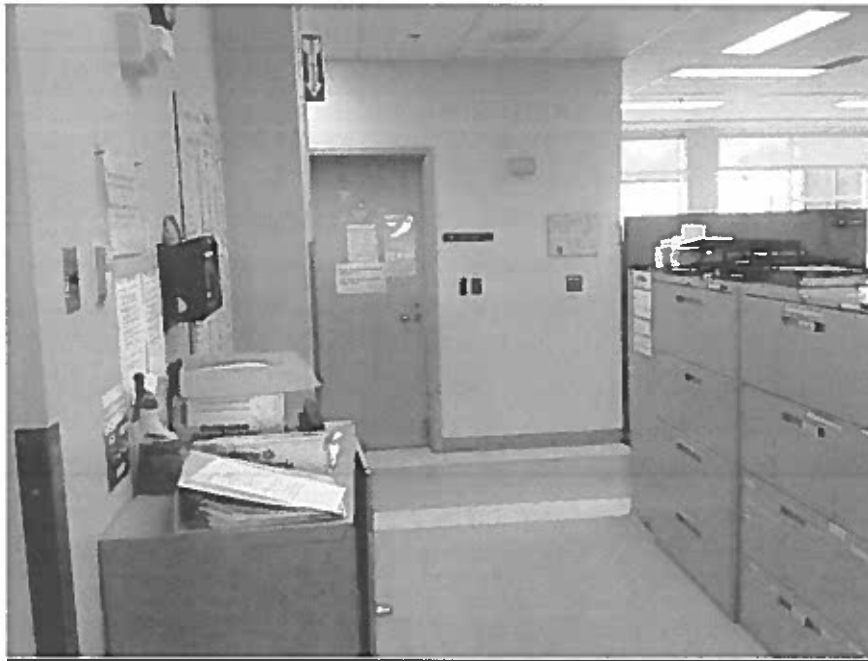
Locaux I-138, I-135 I-113, I-109, I-107, I-137 – Rez-de-chaussée – Composé à joint sur placoplâtre sur mur et plafond, sans amiante, #4-A à 4-I
